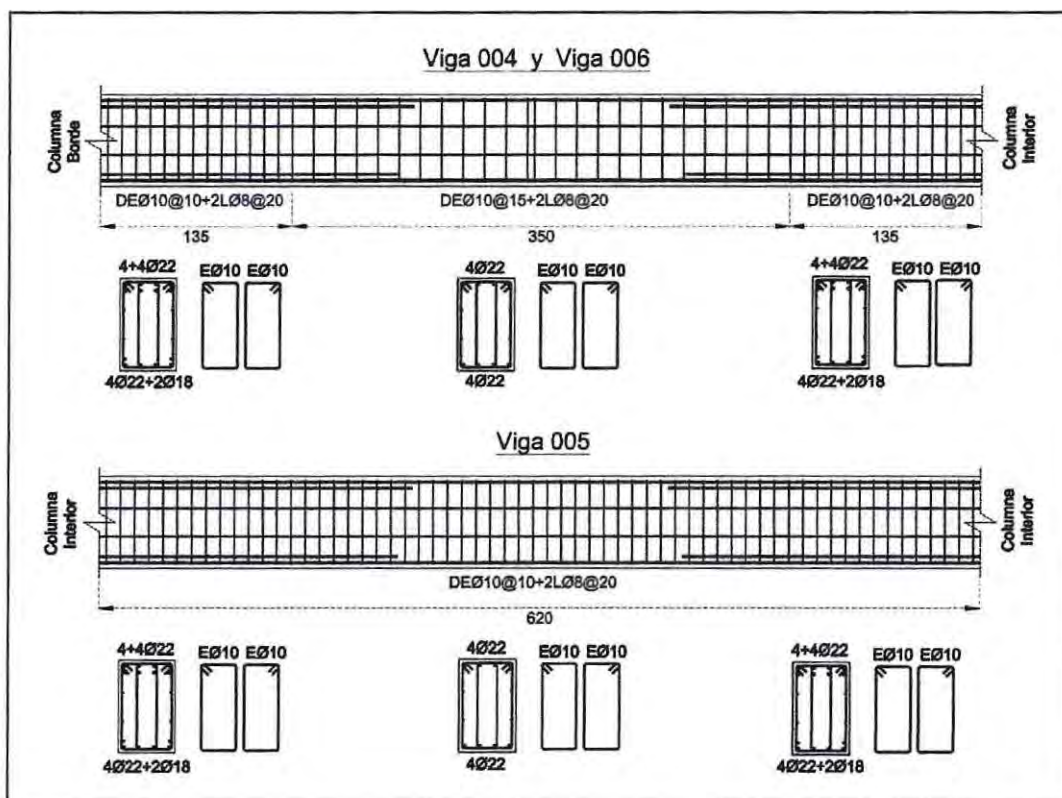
Distribución armadura de corte en vigas Eje A, estructura con marcos.
